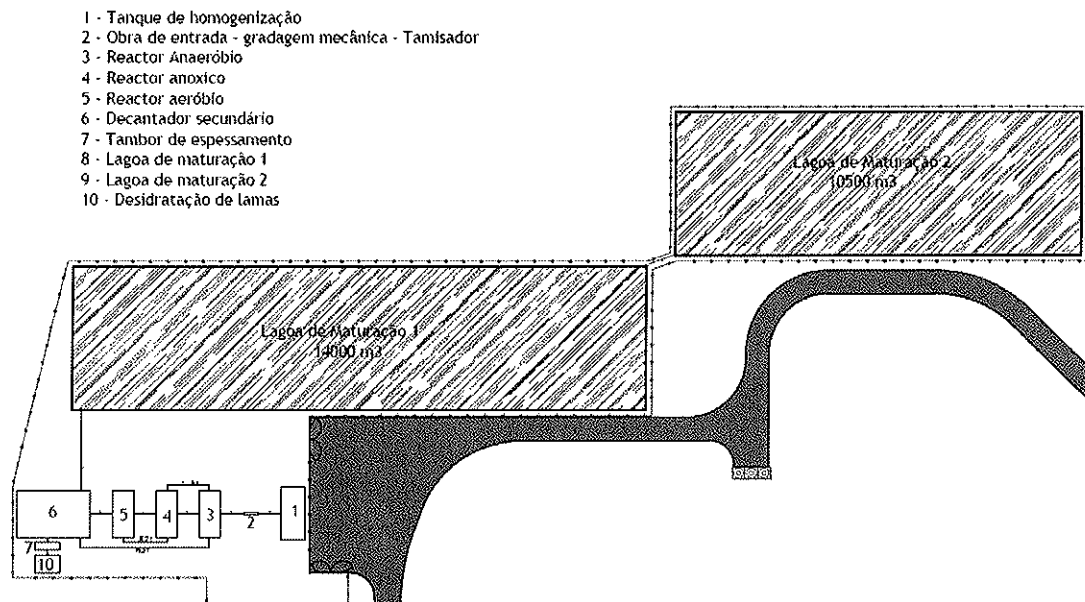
Planta geral da implantação da ETAR (fonte: EIA)
